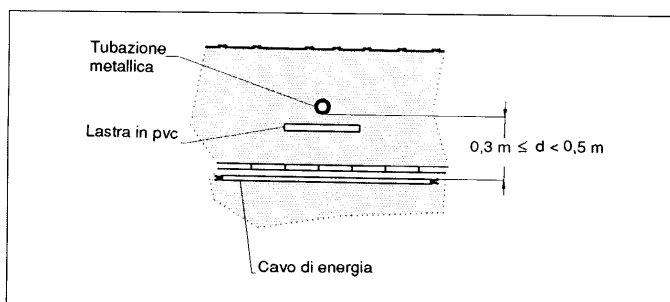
Se il cavo di energia dista dalla tubazione metallica meno di 0,5 m, occorre un elemento separatore non metallico.
